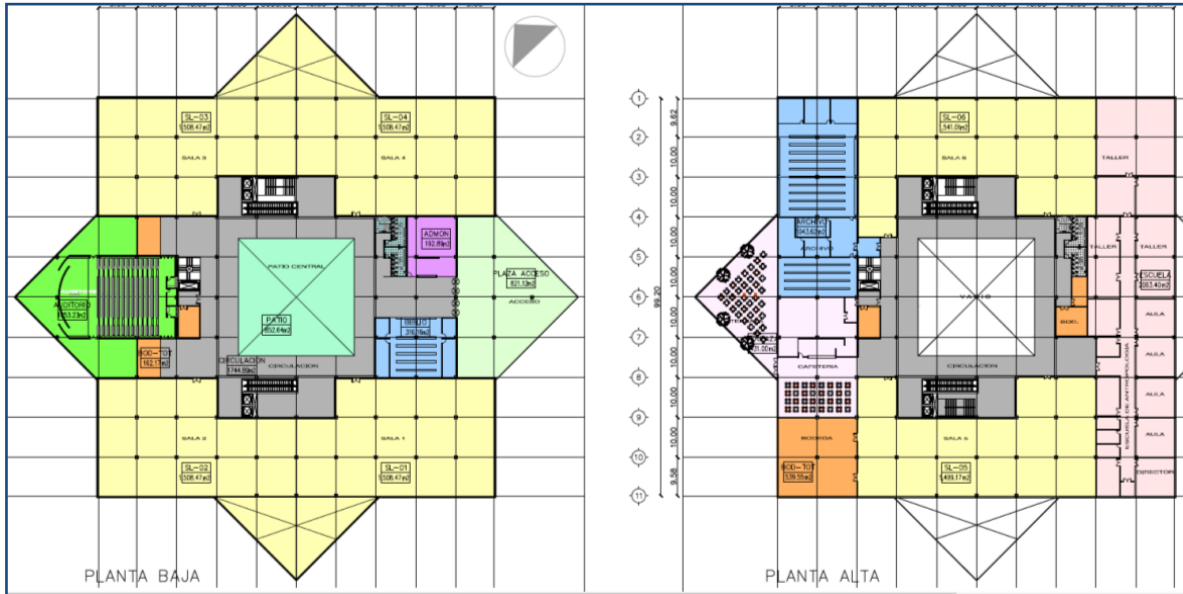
Planta arquitectónica de Museo en planta baja y primer nivel.
